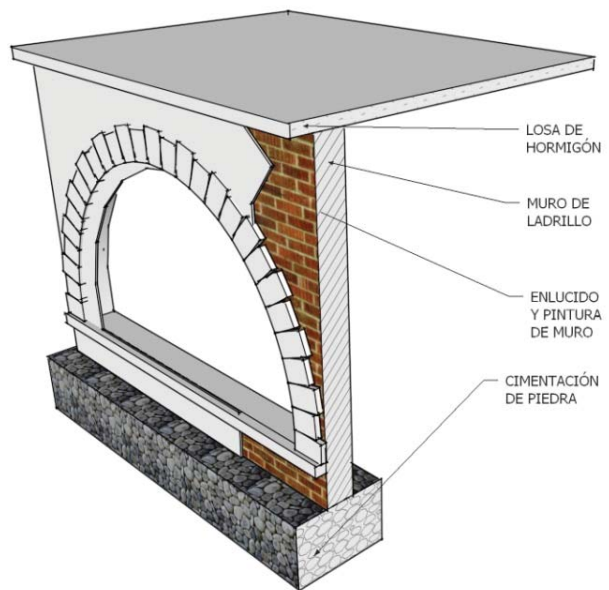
Detalle de muro de ladrillo y losa de hormigón.
